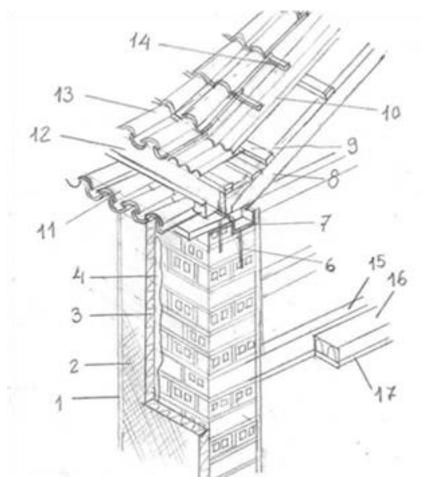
6 - Representação esquemática da zona da parede exterior e cobertura. 1-Reboco de resina do capoto, 2-Véu de fibra de vidro, 3-Aglomerado negro de cortiça de 8mm, 4-Argamassa de colagem, 5-Lajeta de betão, 6-Bucha química de fixação, 7-Viga de coroamento da parede (perfil laminado), 8-Perna da asna, 9-Vara, 10- Subtelha, 11- Telha canudo, 12- Caleira, 13- Telha lusa, 14- Ripa [10 e 11].
